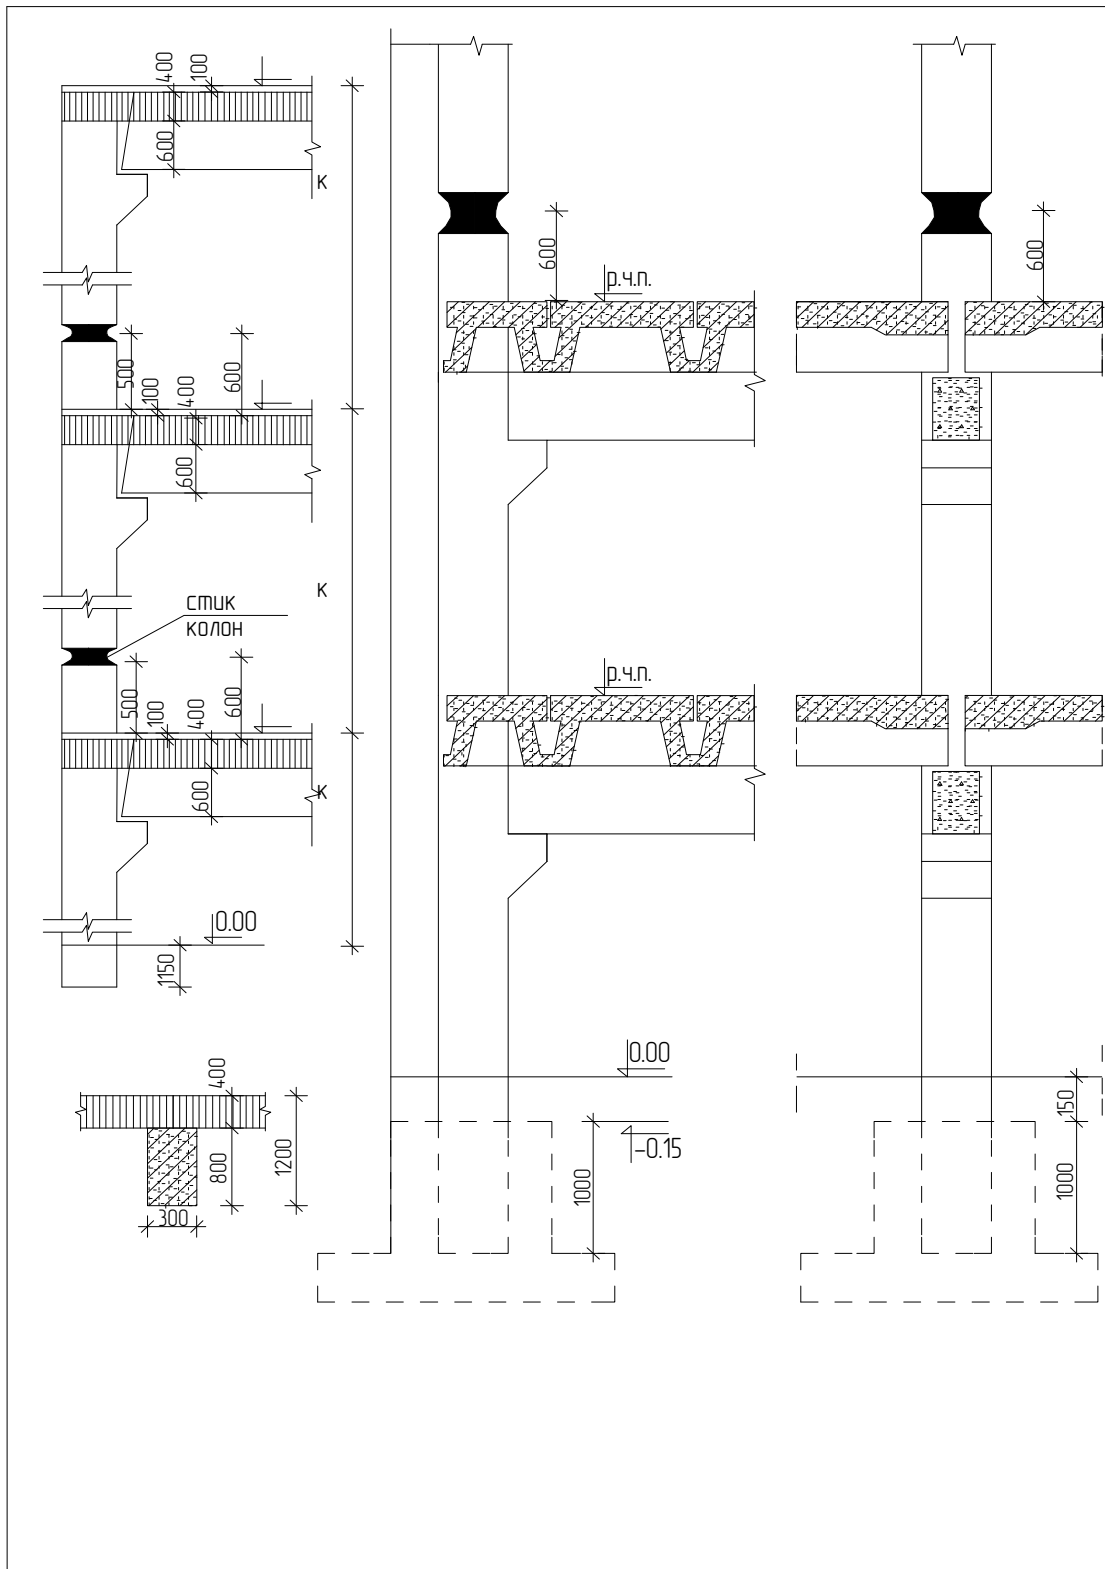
Висотна ув'язка уніфікованих багатопверхових промислових будівель з сіткою колон 6×6 і 9×6 м. Розміщення стиків колон і габарити закладення їх у фундаментні блоки, коли плити перекриття розташовуються зверху ригелів
